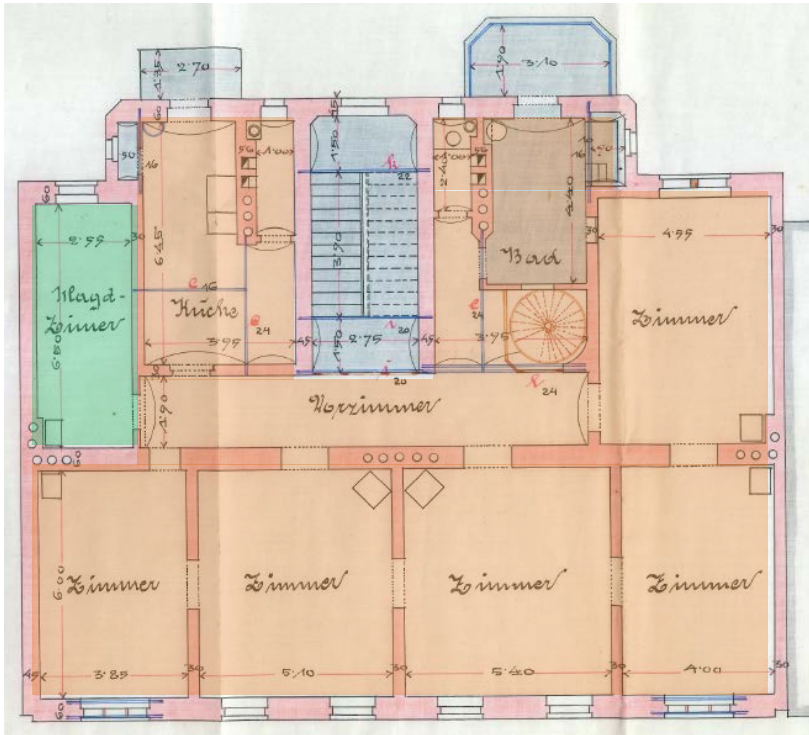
Grundriss Gründerzeitpalais 1. Stock<sup>86</sup>
